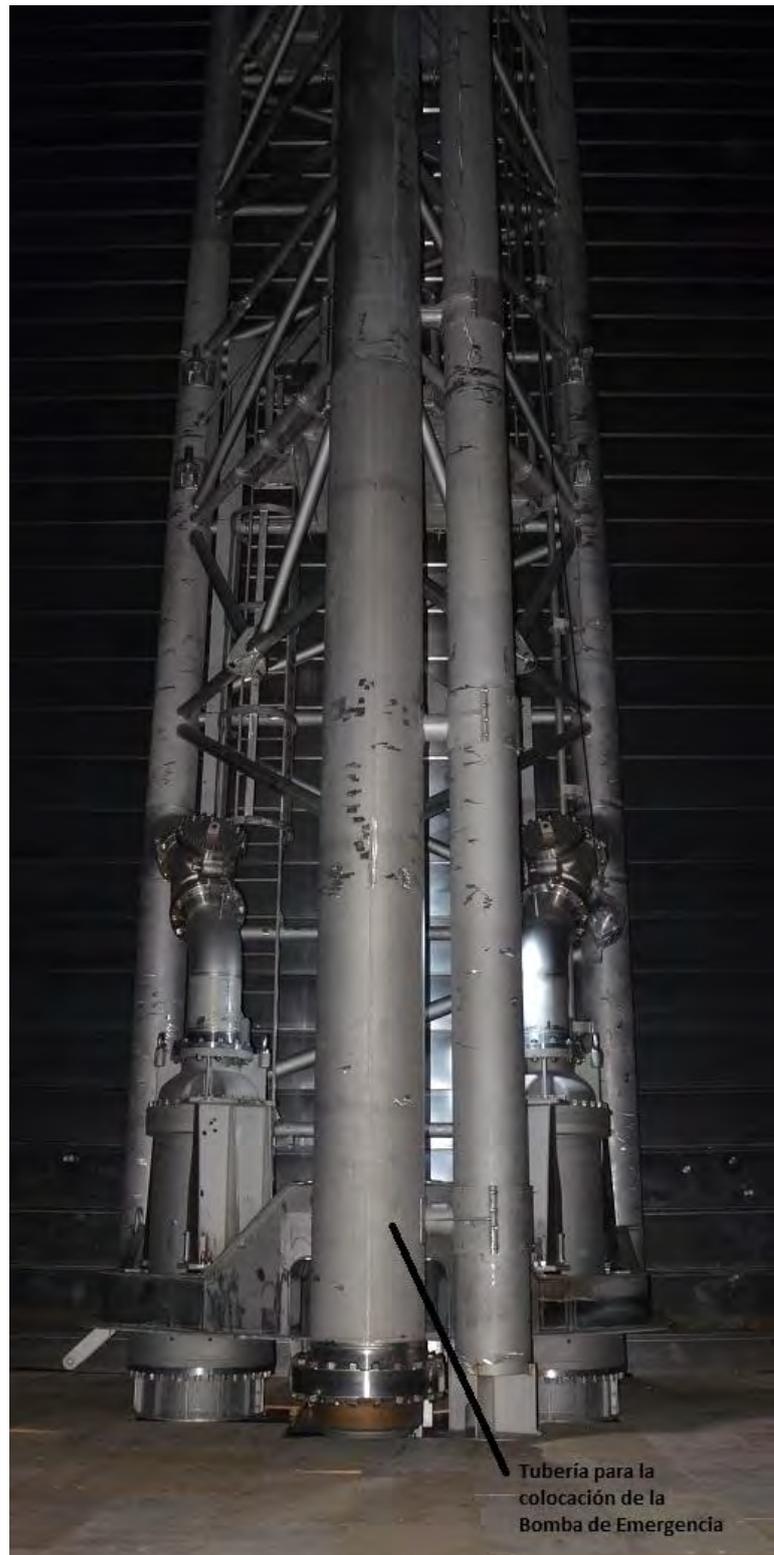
Detalle de donde se coloca la Bomba de Emergencia. Fuente: elaboración propia
